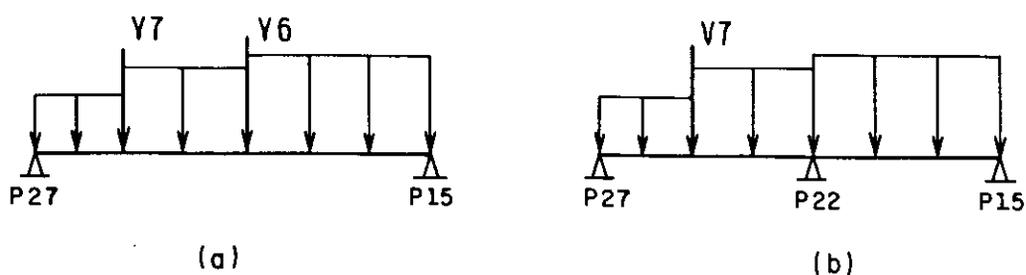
Estudo da Viabilidade da Introdução dos Pilares P22 e P23 da ESTRUTURA III
